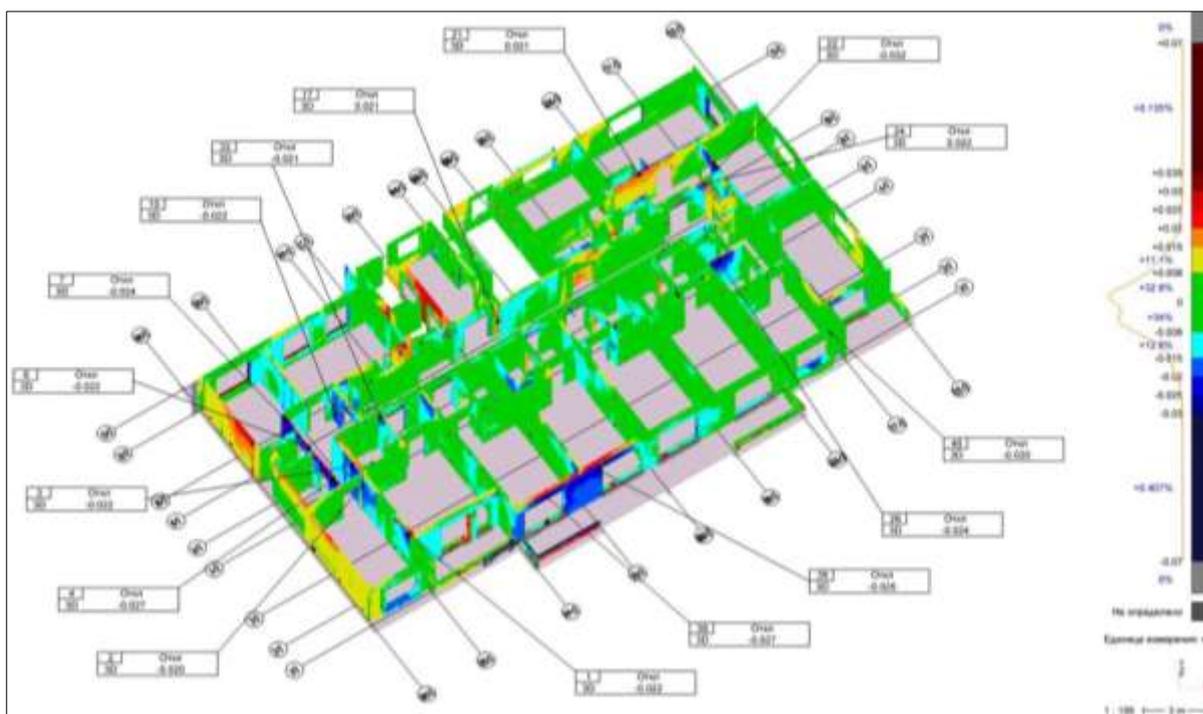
Выявленные отклонения железобетонных стен строящегося здания
